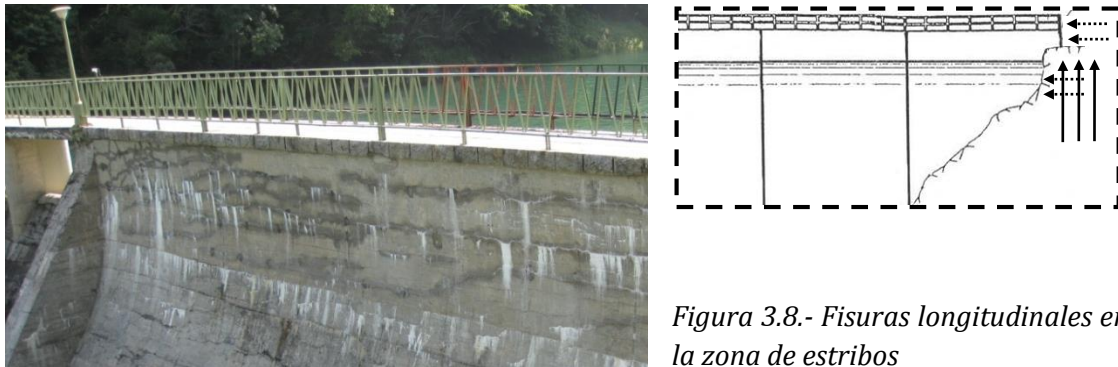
Fisuras longitudinales en la zona de estribos
